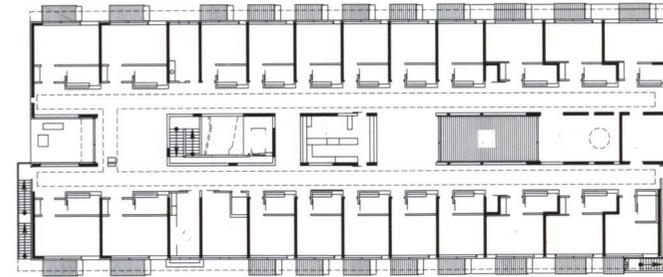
Grundriss 1. Obergeschoss M 1:750
